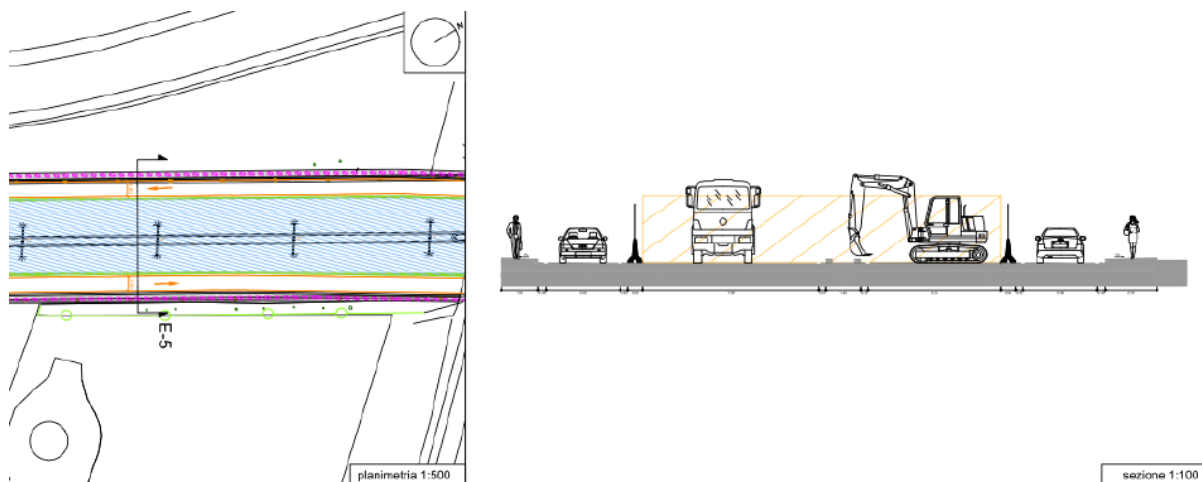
Tipologico cantiere con sede centrale Fase 3
